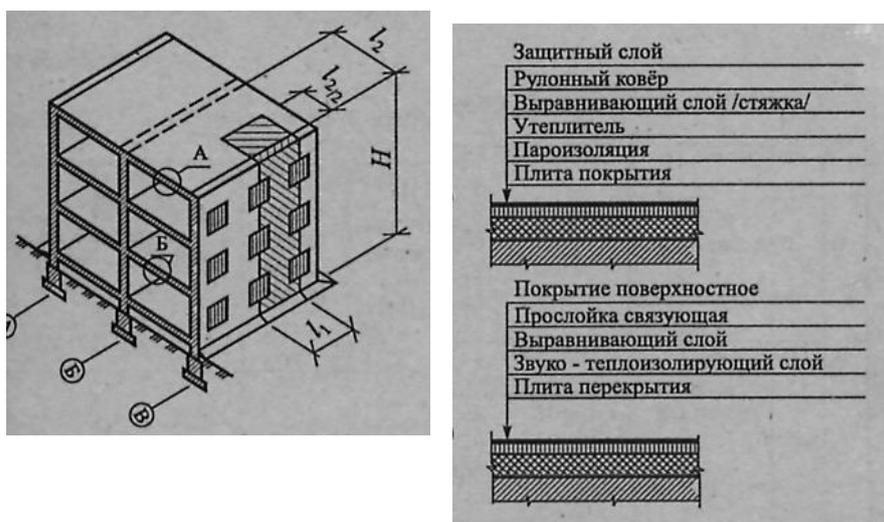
Схема сбора нагрузок для зданий с несущими стенами:
